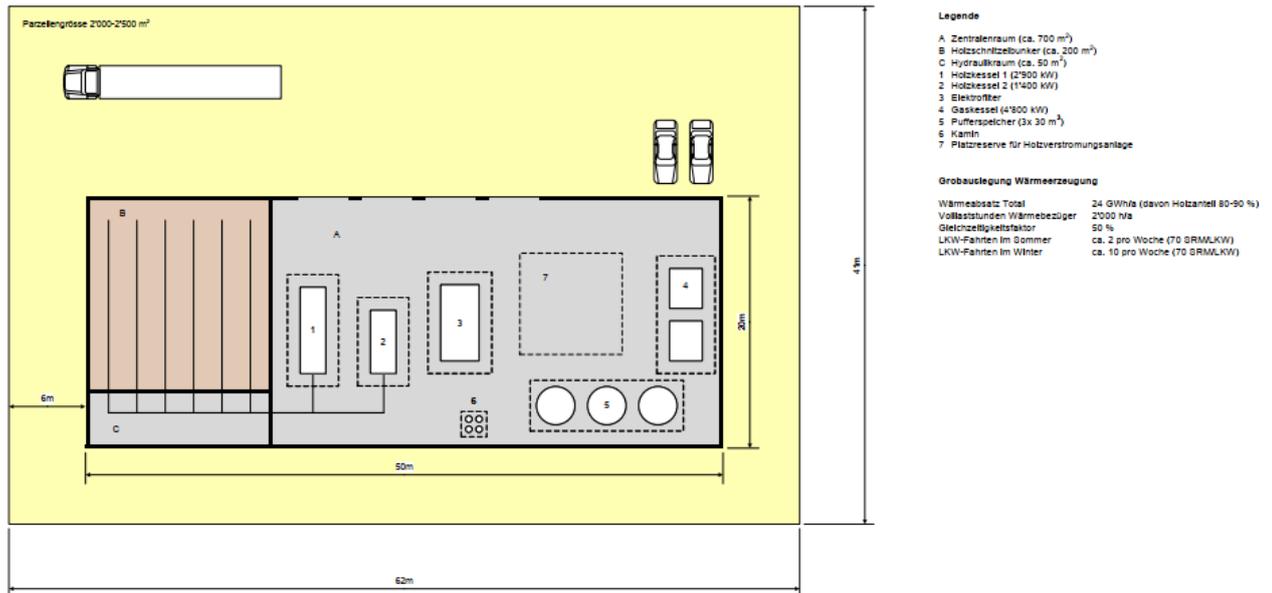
Schematischer Plan einer Holzheizzentrale mit ca. 25 GWh Wärmeabsatz
